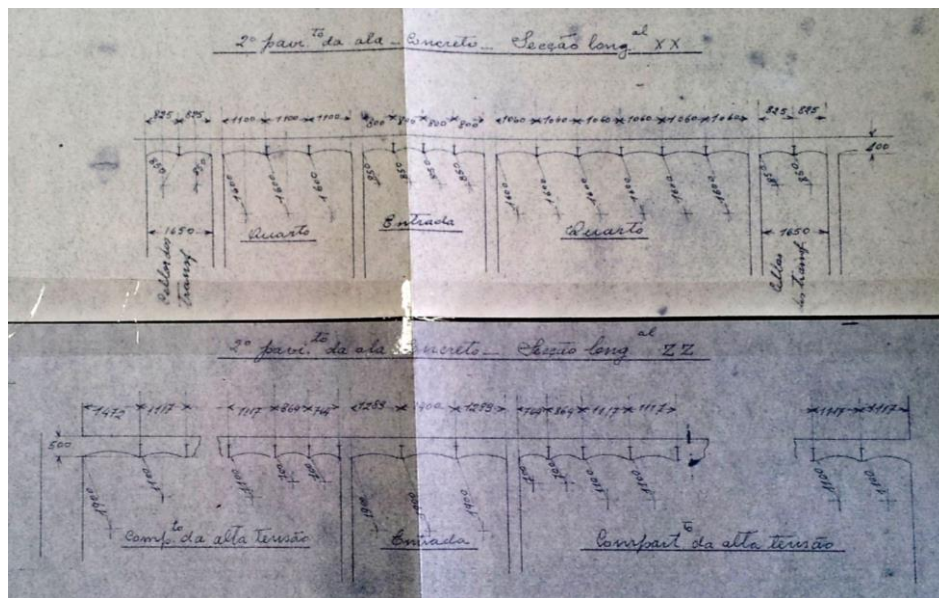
Sistema de abobadilhas entre vigas de ferro do pavimento superior. Trecho da planta Casa da Força, CDS, 1912 (cópia).
